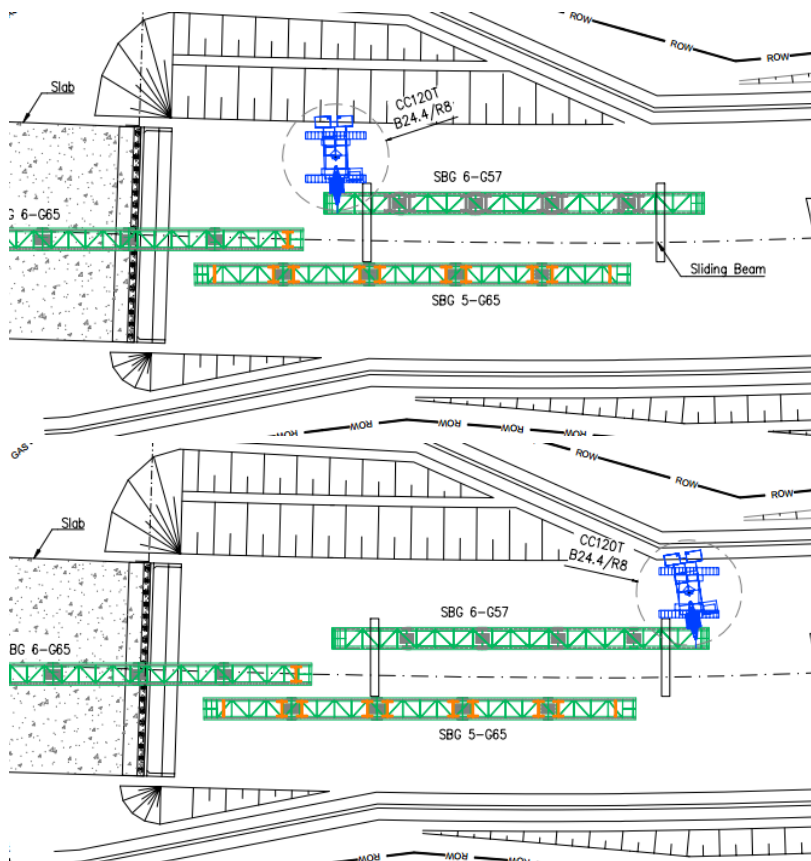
Ilustrasi Pendorongan *Steel Tub Girder* 65 m dan *Nose Beam* (Launching 1)
